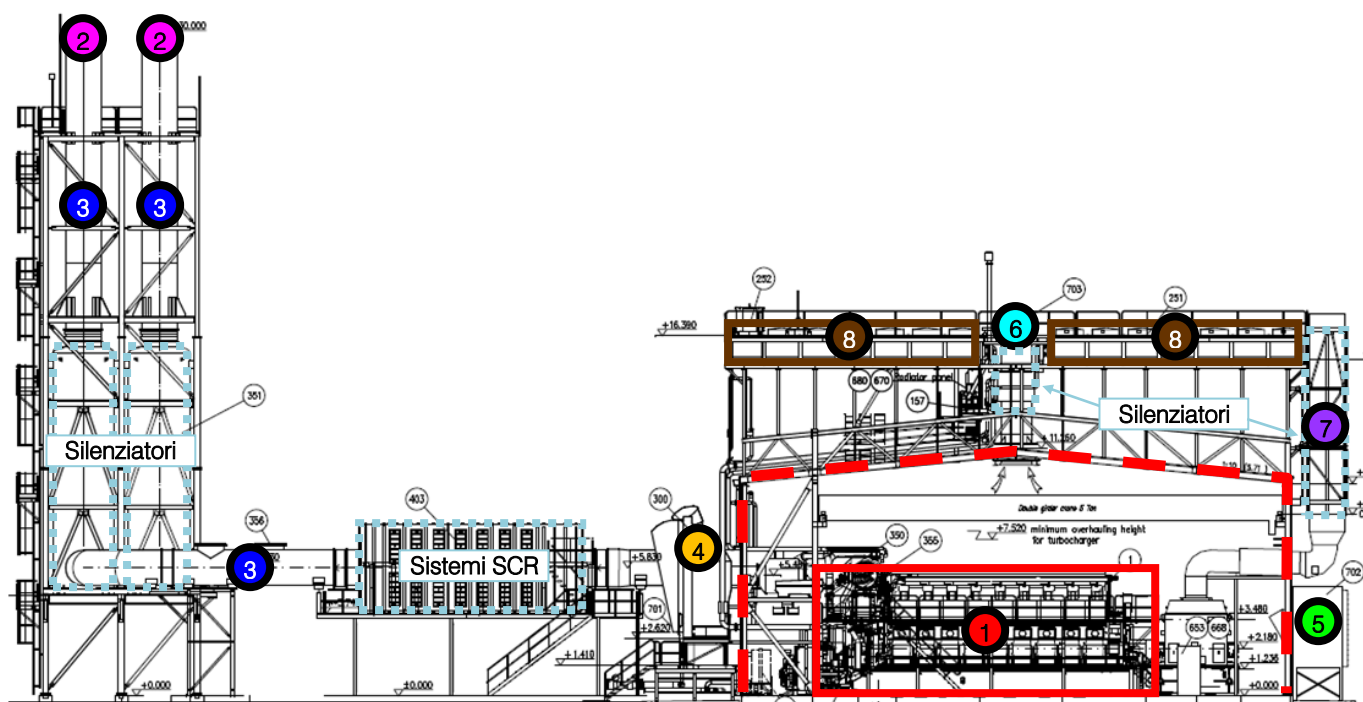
Sezione della centrale in progetto con individuazione delle sorgenti sonore.
